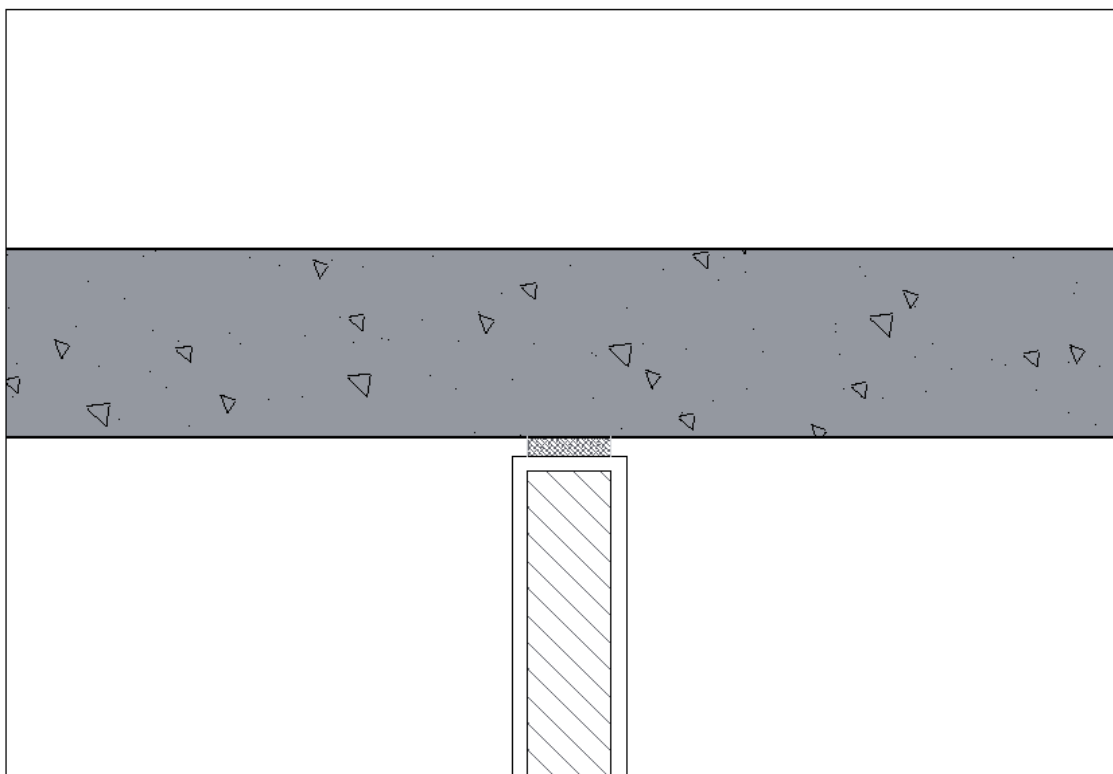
Detalhe da junta parede/laje. Fonte: AUTOR (2017).
